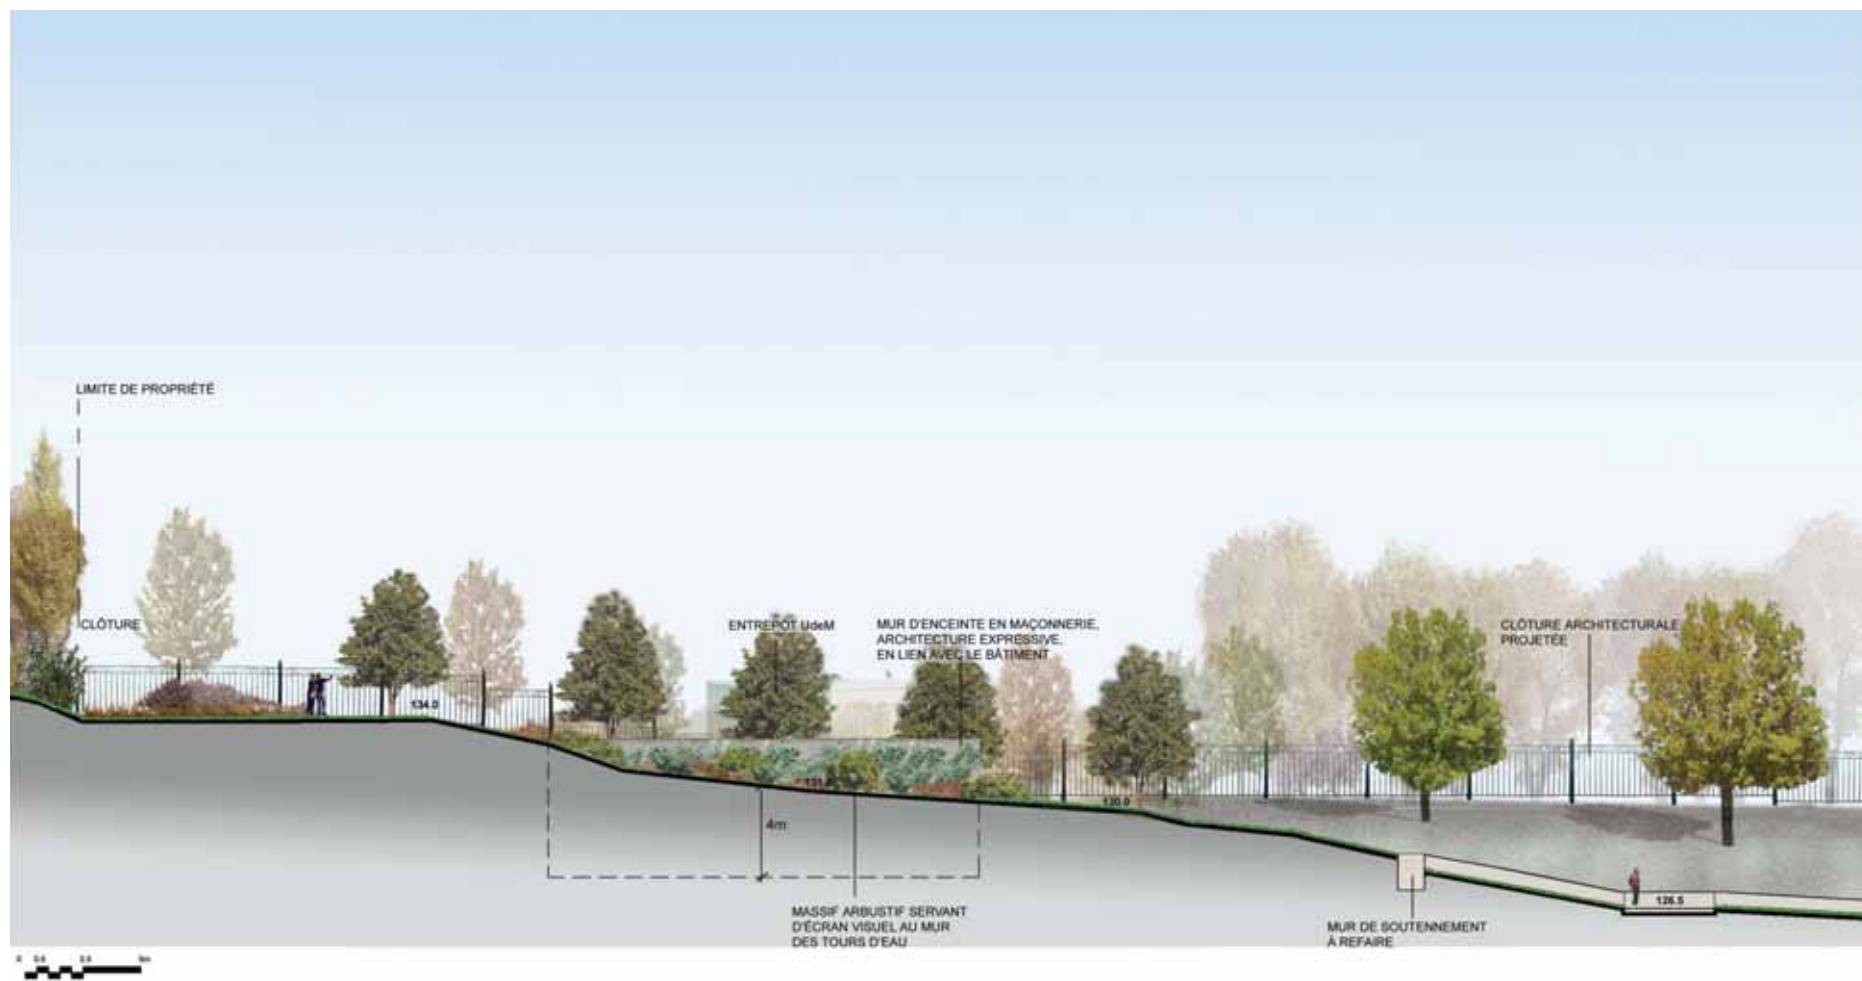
Coupe - élévation longitudinale EE' - Tours d'eau
